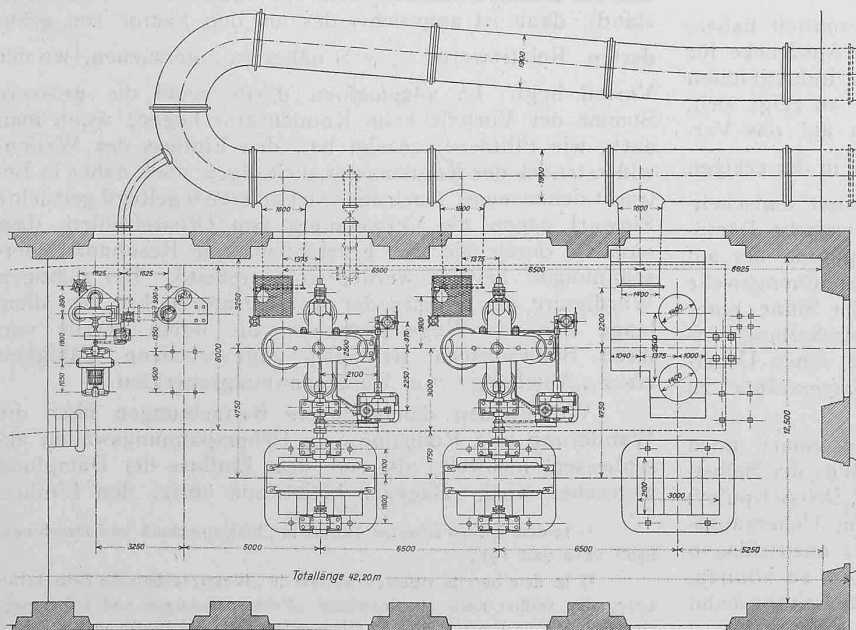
Grundriss der Zentrale Pedesalto. — Masstab 1 : 250.
